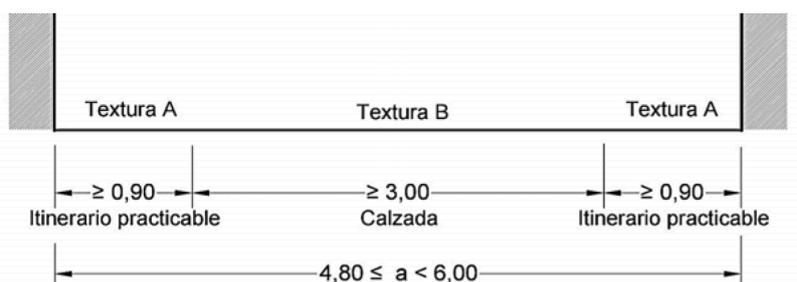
2. Vía de uso mixto con una anchura entre 4,80 m y 6,00 m
